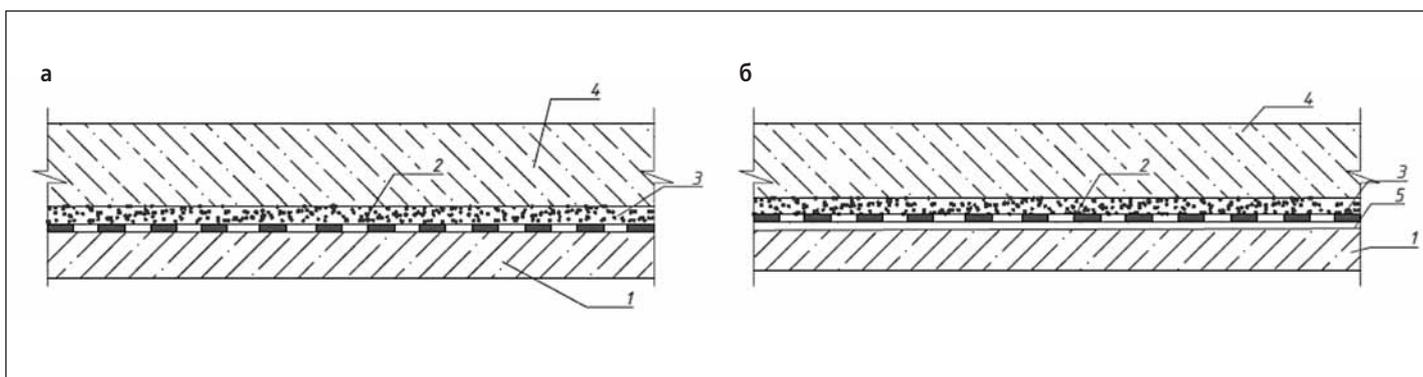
Бесшовная гидроизоляция лотковой плиты с укладкой напыляемых составов с двухсторонней адгезией: а – на бетонное покрытие; б – на подстилающийся слой из геотекстильной ткани; 1 – бетонная подготовка; 2 – гидроизоляционное покрытие; 3 – защитный слой из мелкозернистого бетона; 4 – лотковая (фундаментная) плита; 5 – геотекстильная ткань
